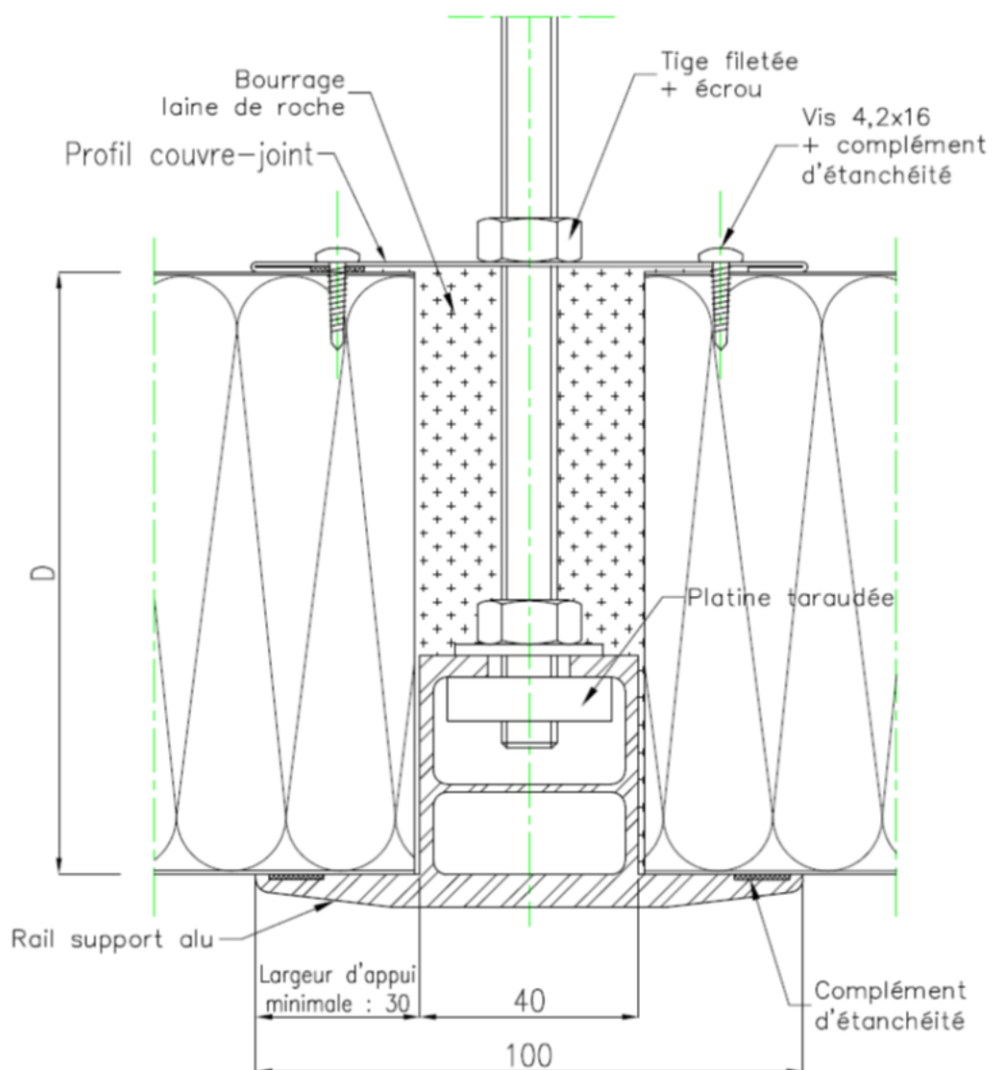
Schéma 2 - Panneaux reprise plafond - Reprise par rail alu - la largeur minimale d'appui sur les ailes de l'oméga est de 30mm.
